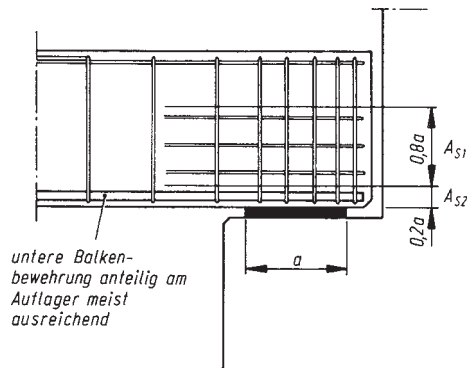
Bewehrungsanordnung im Bereich eines Balkenaufagers (Beispiel nach DIN 4141-5)
